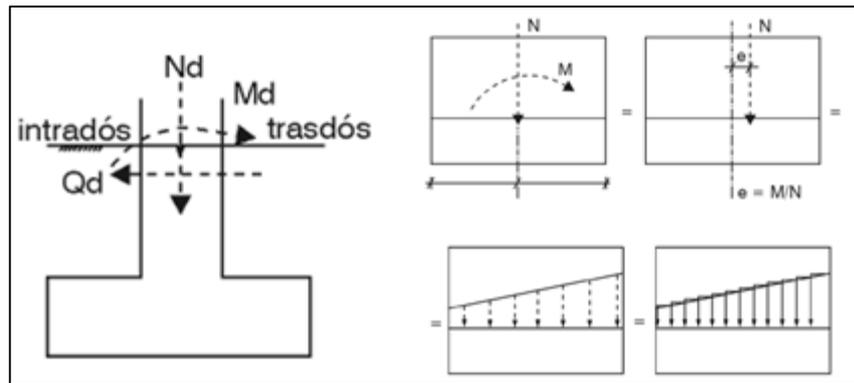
Esquema de esfuerzos transmitidos a la zapata corrida
